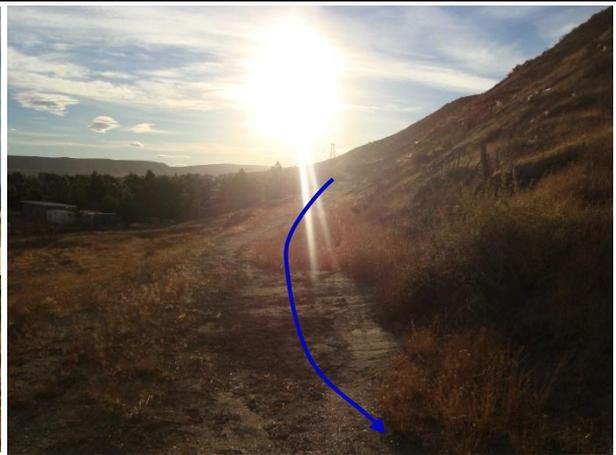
Sitio futura cámara válvula de aire N°3, continúa por picada existente. - Tramo 15-16
